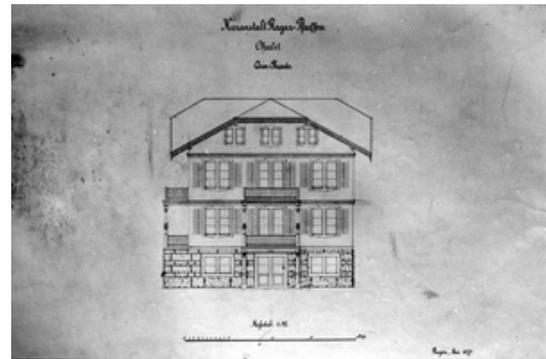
Bad Ragaz, Plan 40, Chalet Querfassade, 1873
